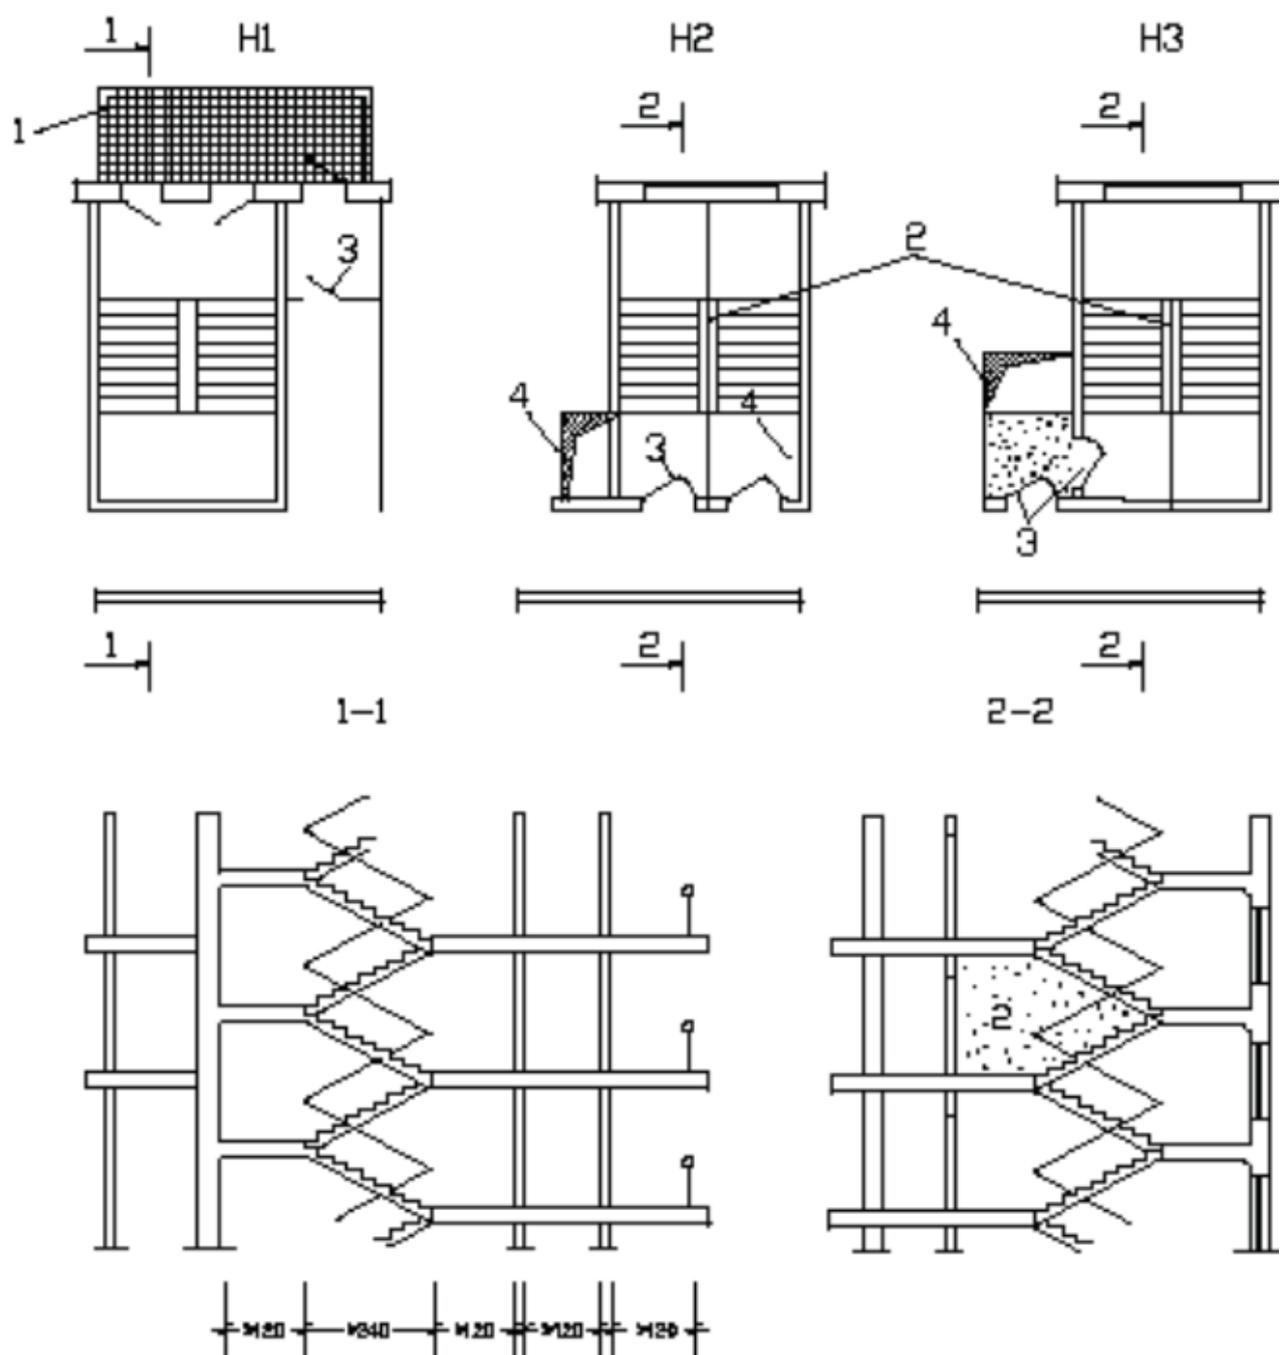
План незадымляемых лестничных клеток типов Н-1, Н-2, Н-3:
